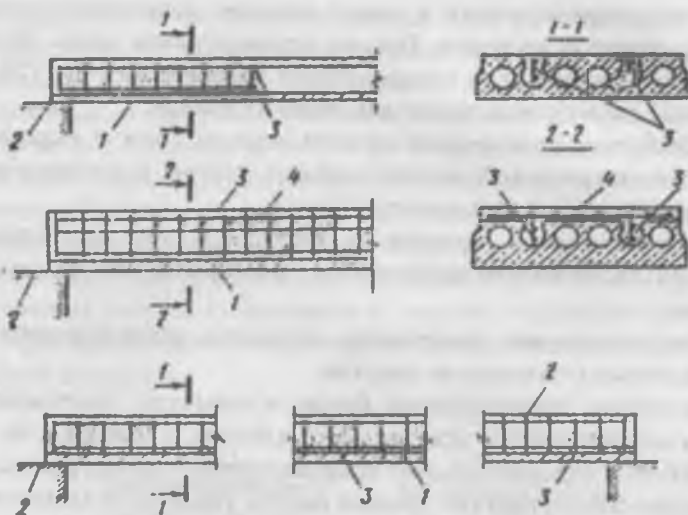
Усиление сборных многопустотных плит перекрытия:
